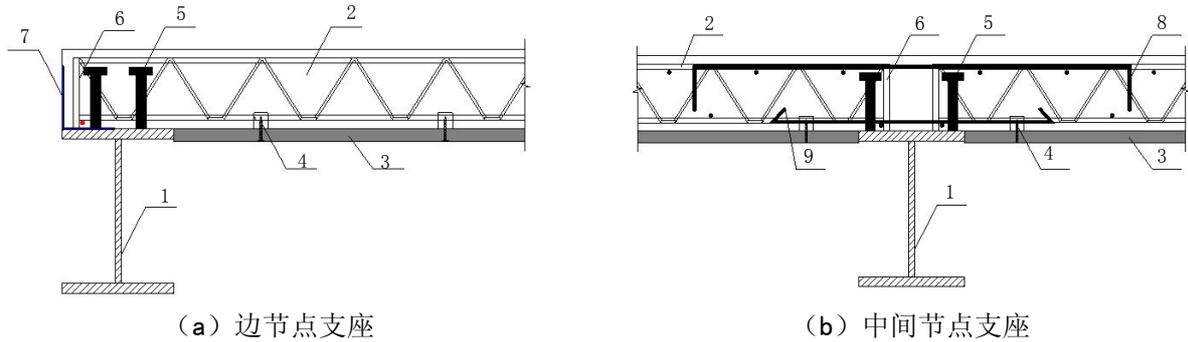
竹基底模楼承板与钢梁支座连接构造示意
